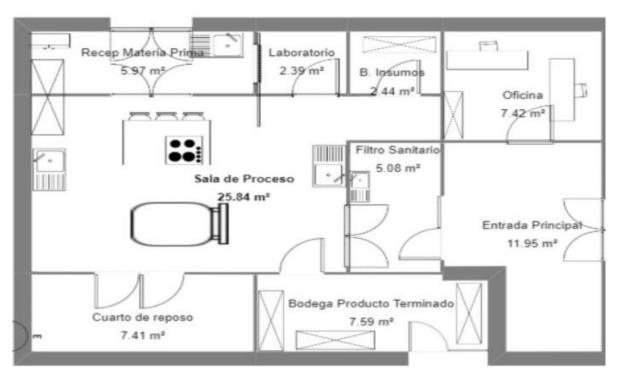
Planos de Distribucion de Planta de procesamiento
